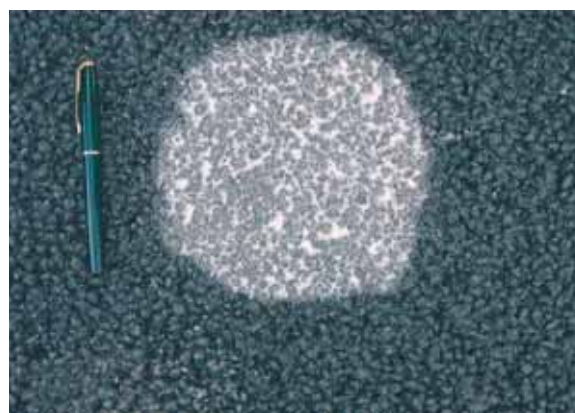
Essai de hauteur au sable et texture d'un revêtement Miniphone
